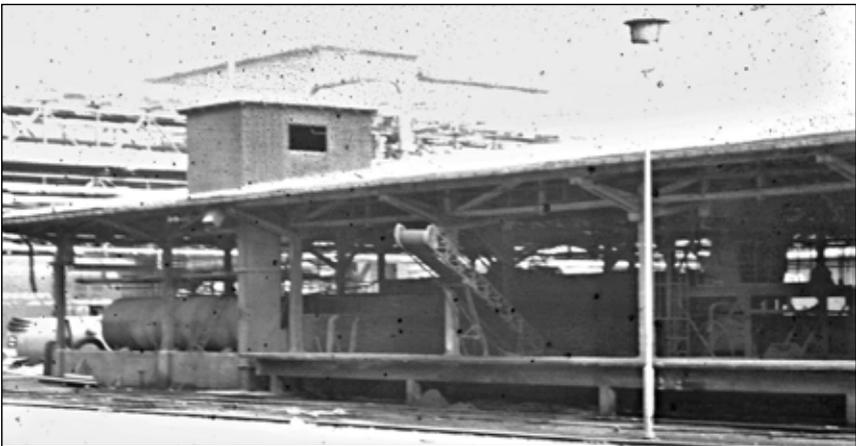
Bau B 47 mit Lagertanks und Berieselung in den 1950/60er Jahren
